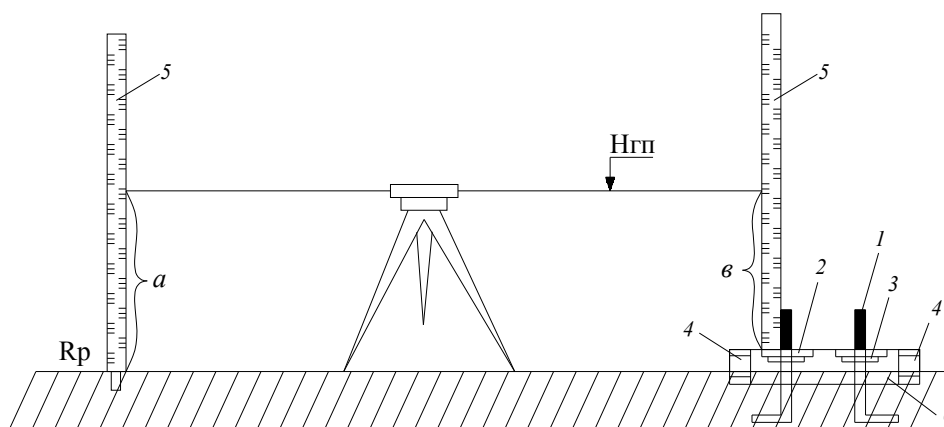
Установлення шайби з гайкою анкерного болта на проектну позначку: 1 – анкерний болт; 2-шайба; 3-гайка; 4-закладні деталі; 5-рейки; 6-шар цементного розчину
